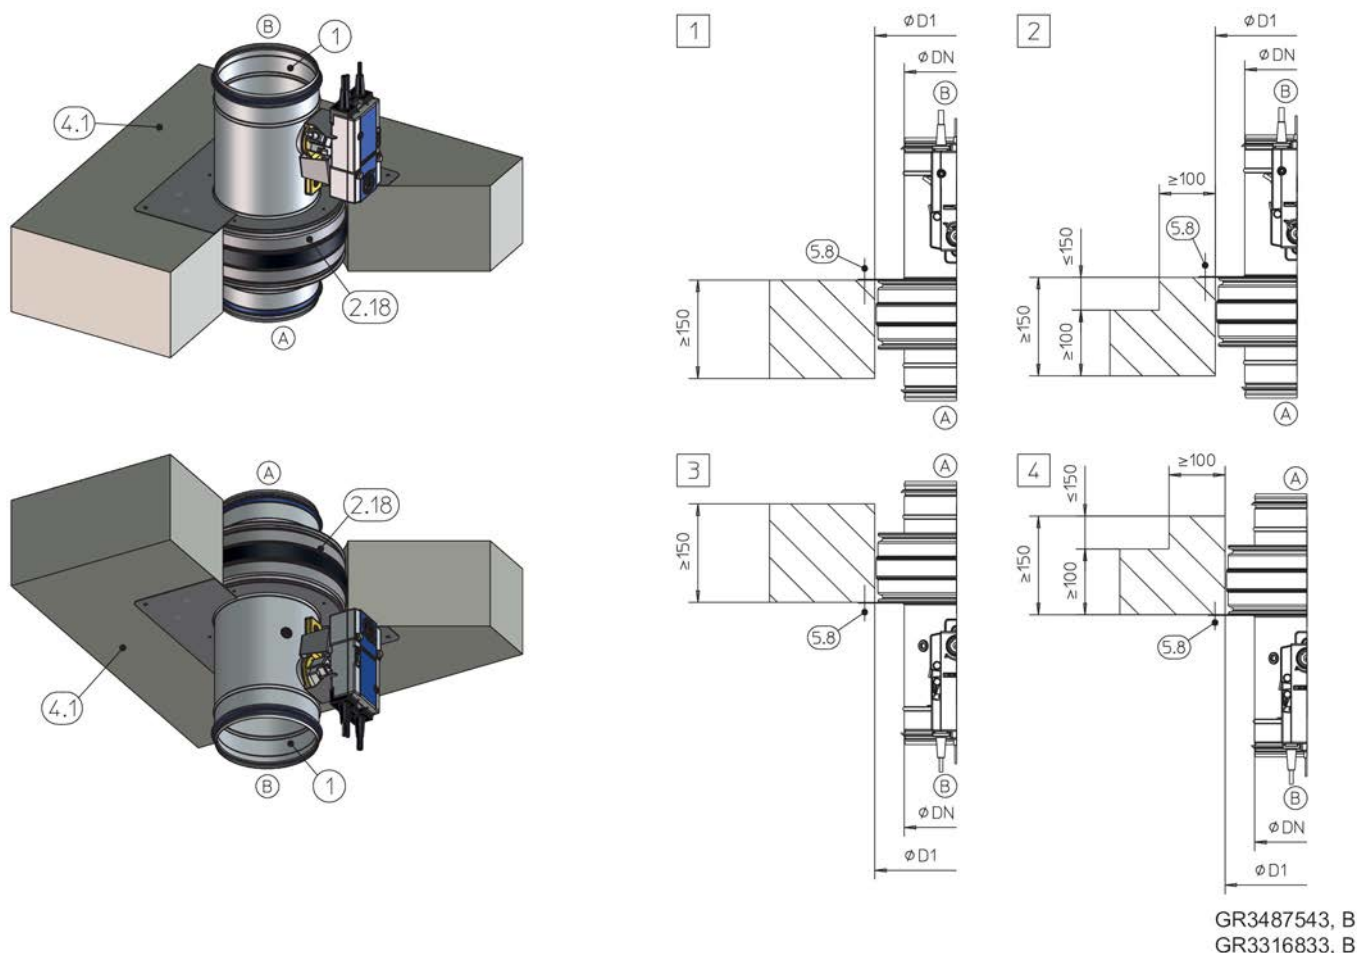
Installazione a secco senza malta con blocco di installazione ER in soffitti pieni a soletta, verticale o sospesa
